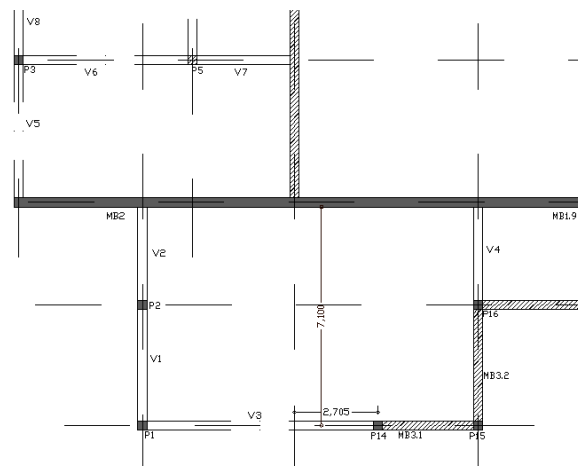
Vão condicionante de pré-dimensionamento do piso 1
